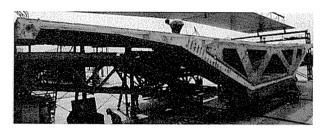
D6 pier segment 図 - 6 D6 柱頭部セグメント
